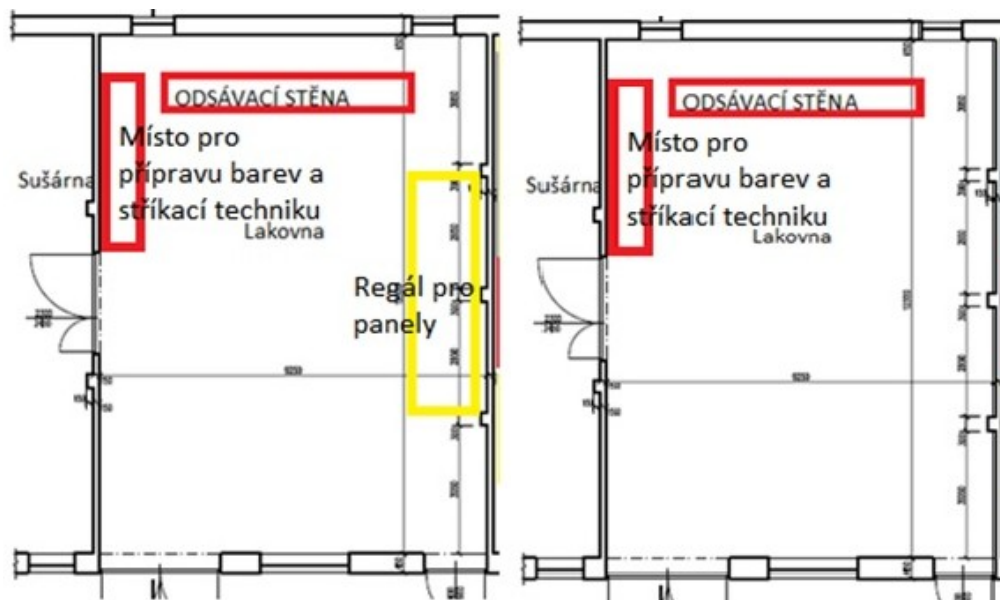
Layout Hala I po změně, vlastní zpracování
